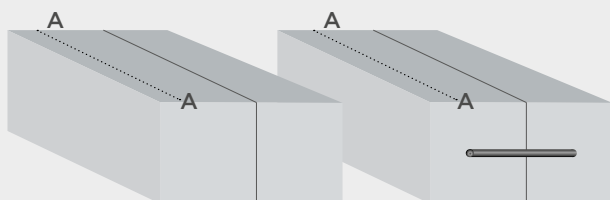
JOINTS DE CONSTRUCTION TRANSVERSAUX
